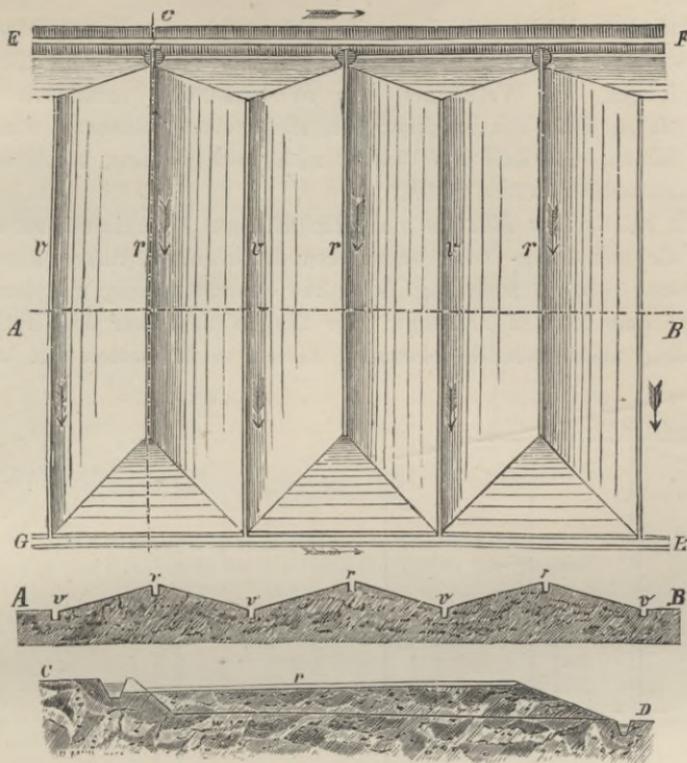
Rückenbau. Grundriss, Querschnitt und Längenschnitt.
